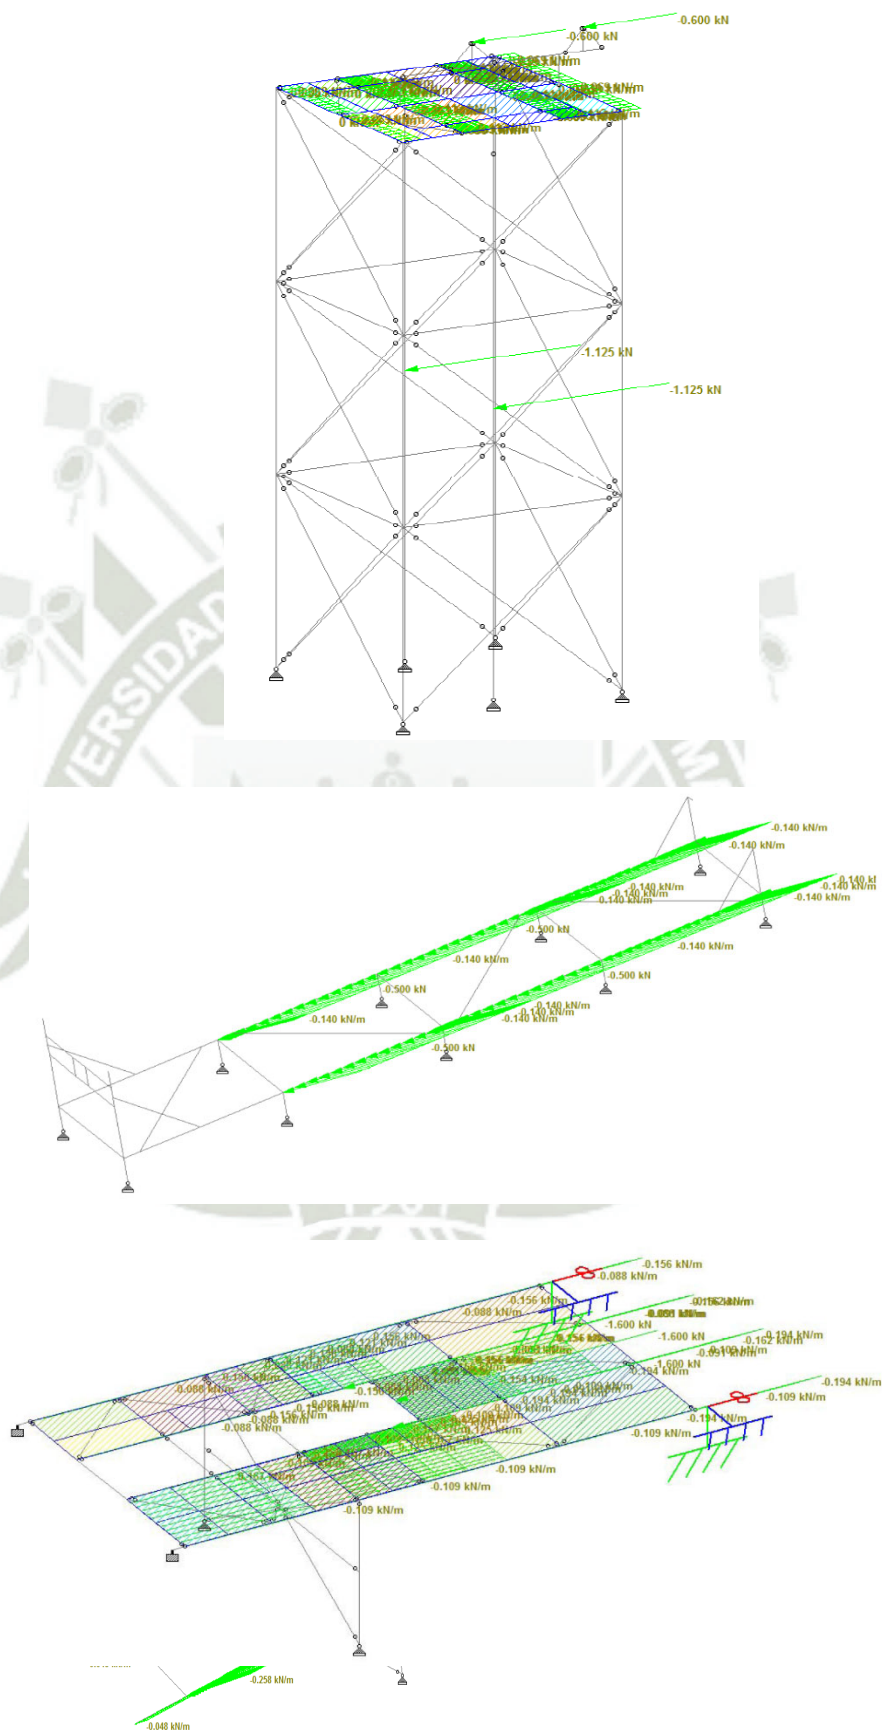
Carga Tipo 13 (E-X) Aplicada a la estructura
